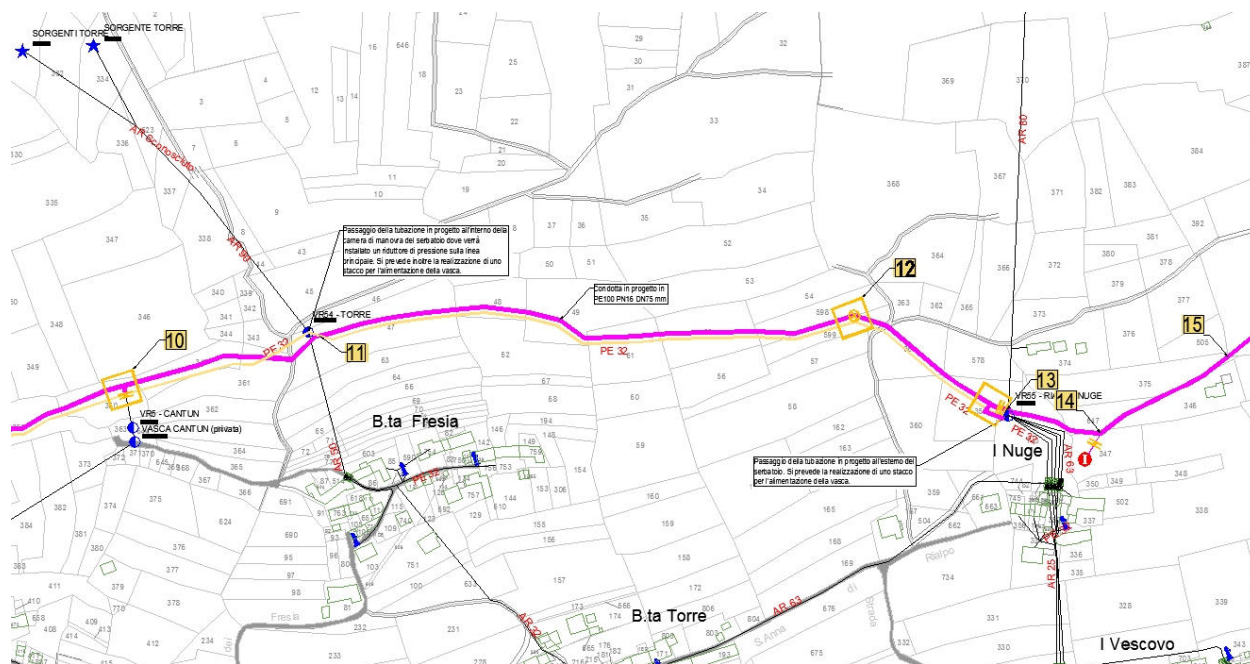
nuova condotta a progetto tra la Sezione 11 e la Sezione 13 su stralcio planimetria catastale.
